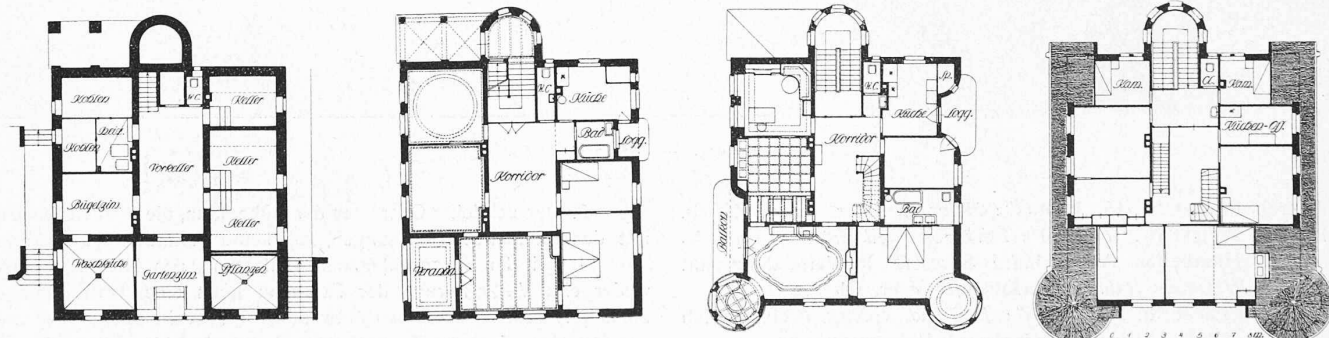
bis 5. Grundrisse vom Untergeschoss, Erdgeschoss, I. Stock und Dachstock. — Masstab 1 : 400.
